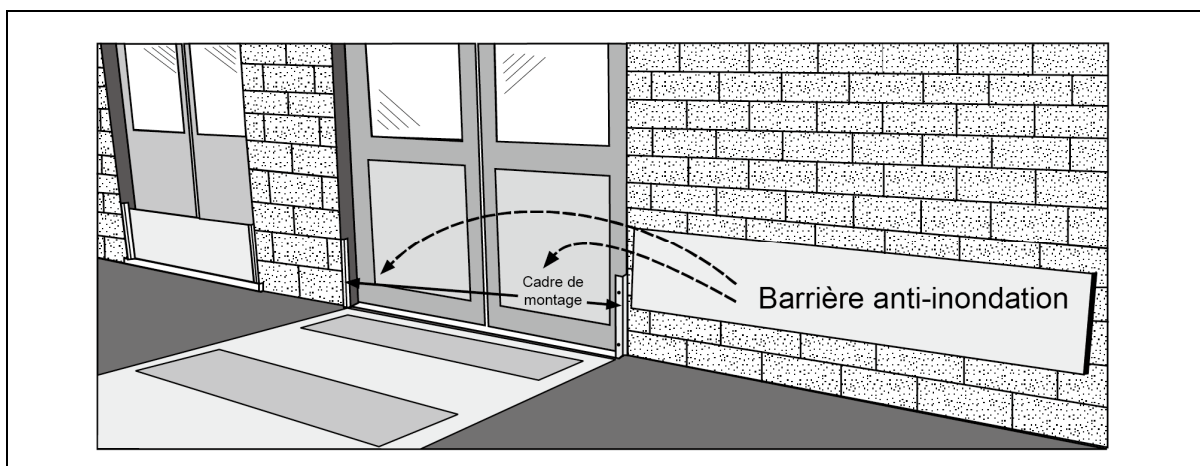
Barrière à insérer, représentée en position de stockage à côté de la porte
